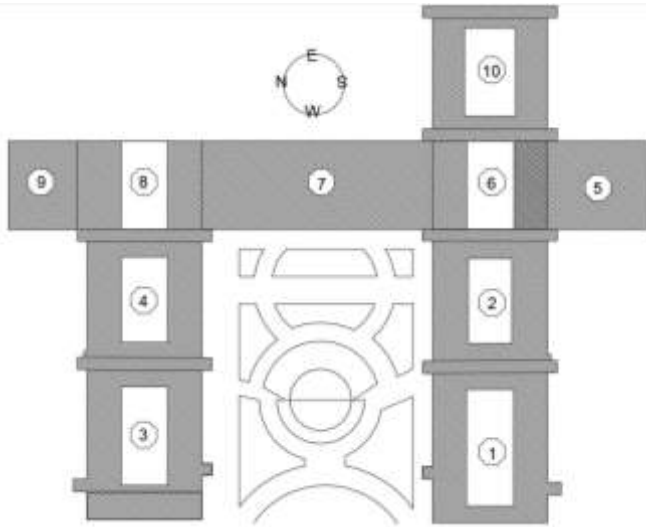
مسقط أفقي لجامعة اليرموك الخاصة
